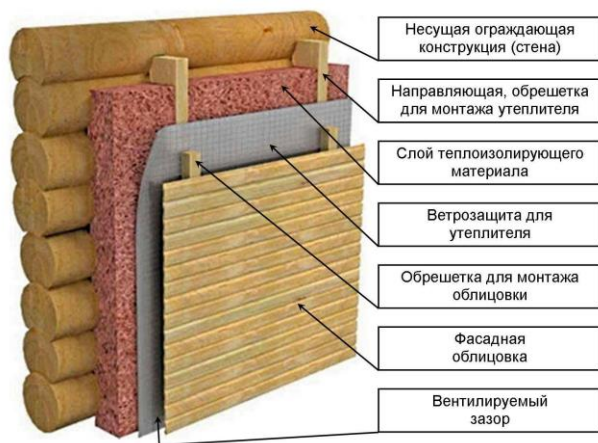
Монтаж слоев фасадного утепления деревянного дома [5]
